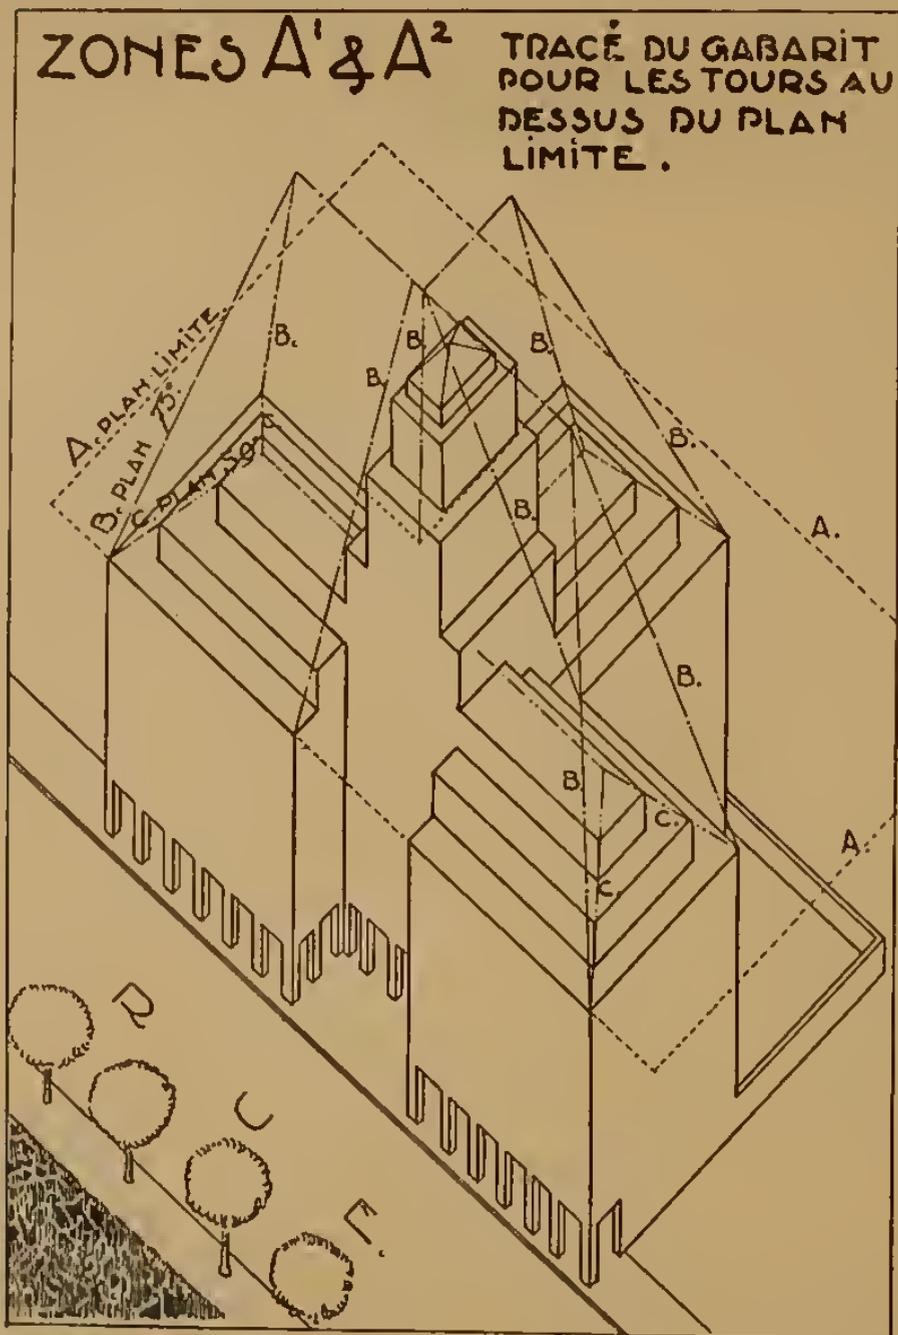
Zonas A¹ e A². Perfil para torres acima do plano limite.
